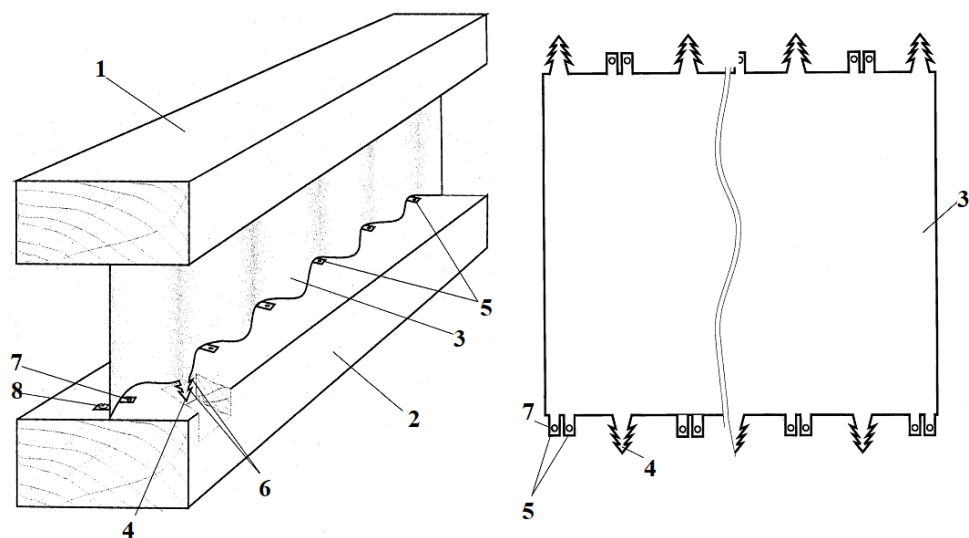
Общий вид металлодеревянной балки (слева) и развёртка металлической стенки с врезными элементами (справа): 1 и 2 – верхняя и нижняя полки; 3 – металлическая стенка; 4 – врезной установочный элемент; 5 – упоры; 6 – зацепы; 7 – отверстия; 8 – крепежные элементы
